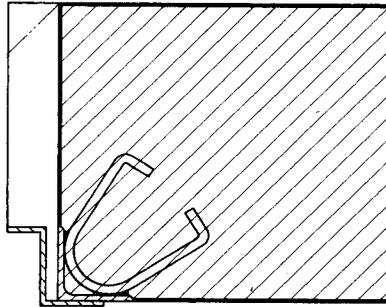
Anschweißanker, Einbaubeispiel (Grundriß) dicke Wand, nur Leibungsfläche geputzt, Befestigung der Zarge am Anschweißanker mittels Paßstücken und Schweißung (nicht dargestellt)
